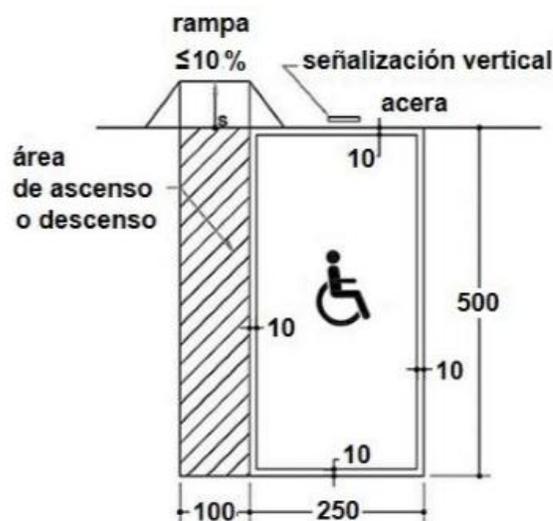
Vista en planta de estacionamiento para personas con discapacidad
